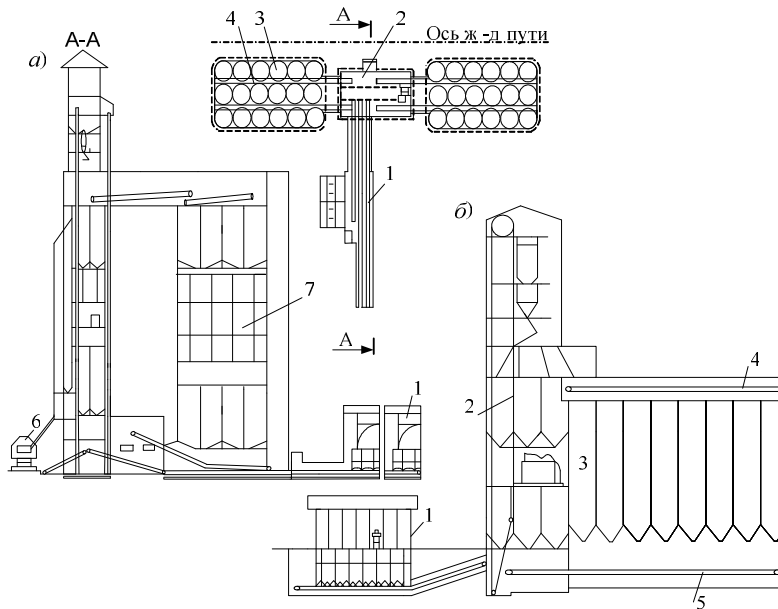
Заготовительный элеватор для зерна:
